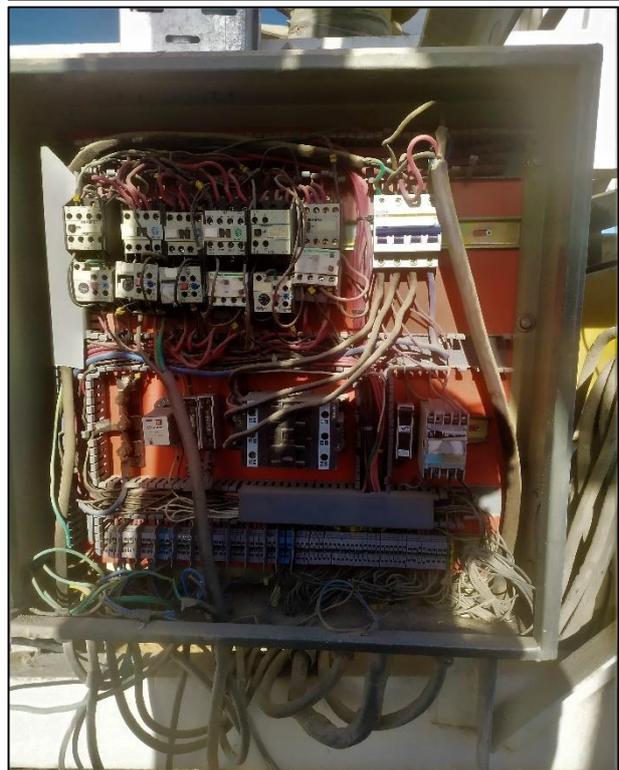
Tablero principal ubicado en planta dosificadora de áridos.
